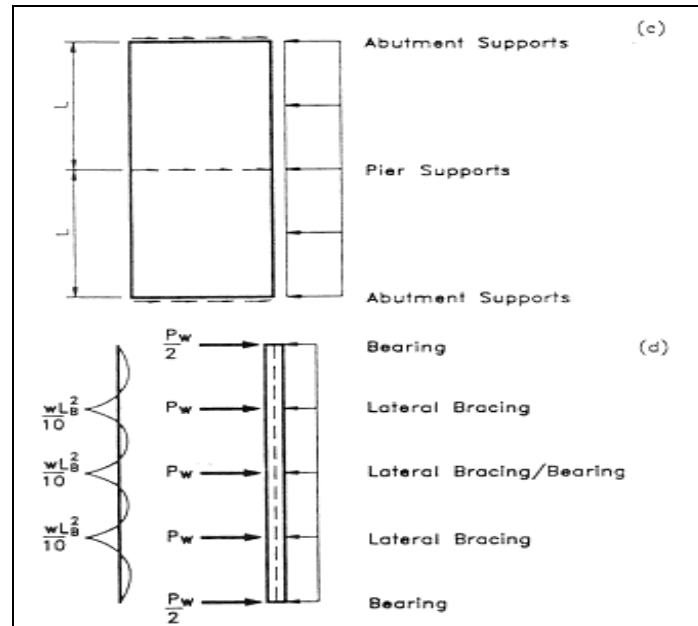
(c) Vista en planta, (d) cargas sobre patín inferior.
